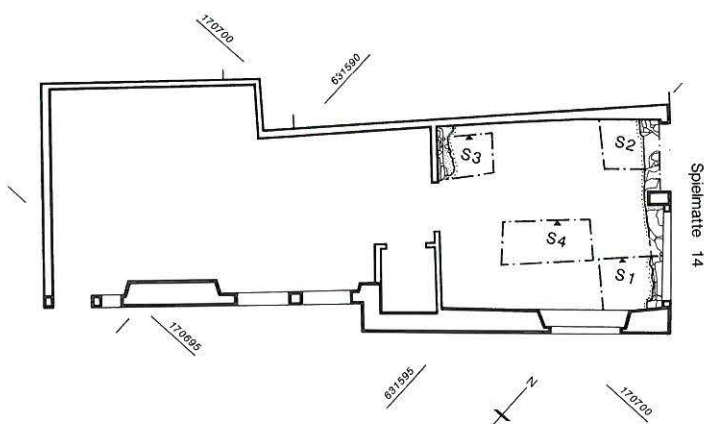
Unterseen, Spielmatte 14. Grundriss Erdgeschoss. M. 1:100.
